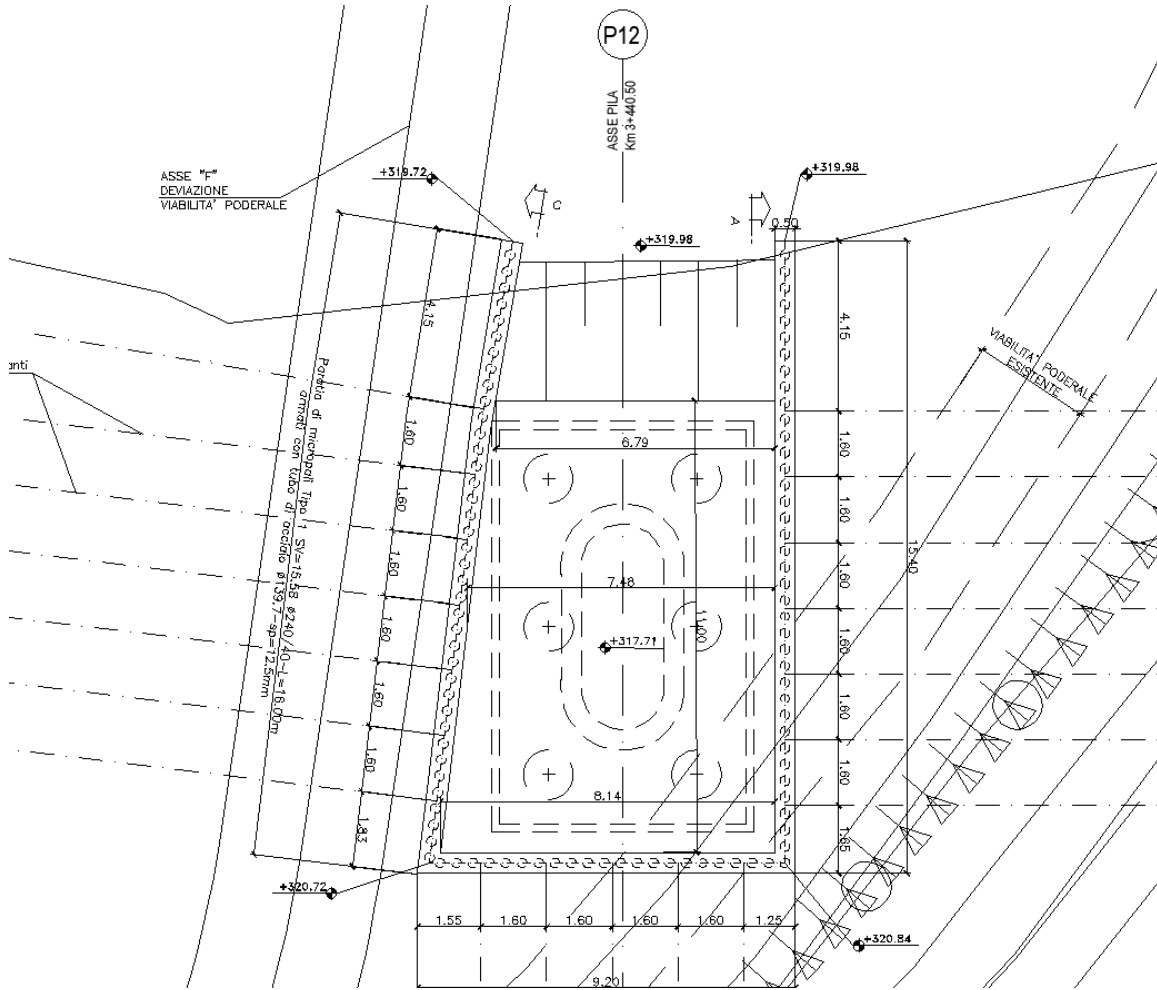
Planimetria dell'opera provvisoria Pila 12
